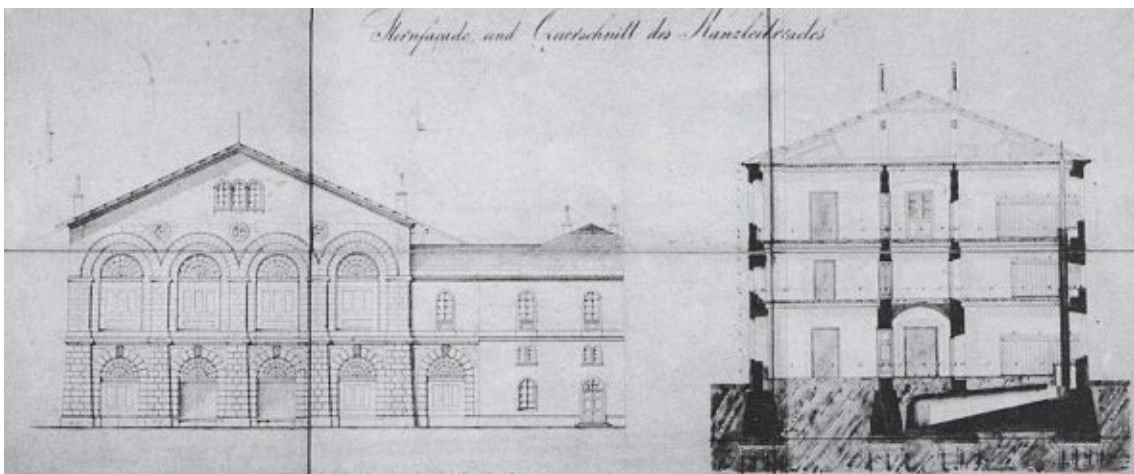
Fassadenansicht und Schnitt des dreistöckigen Verbindungsgebäude zwischen den Sylos
